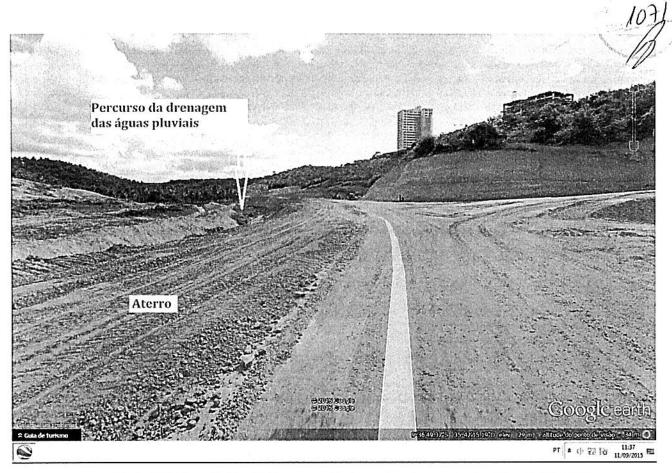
Condição do Terreno 6 durante obras da Av. Pierre Chalita
